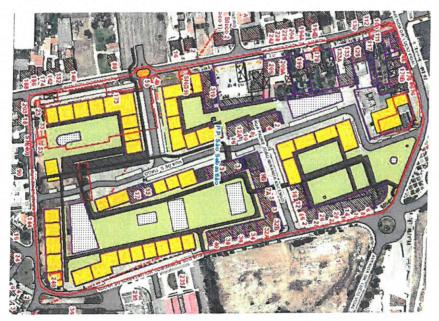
Planta de Implantação PPSS em vigor\_2008 (Fonte: SIG\_CM Vagos)
